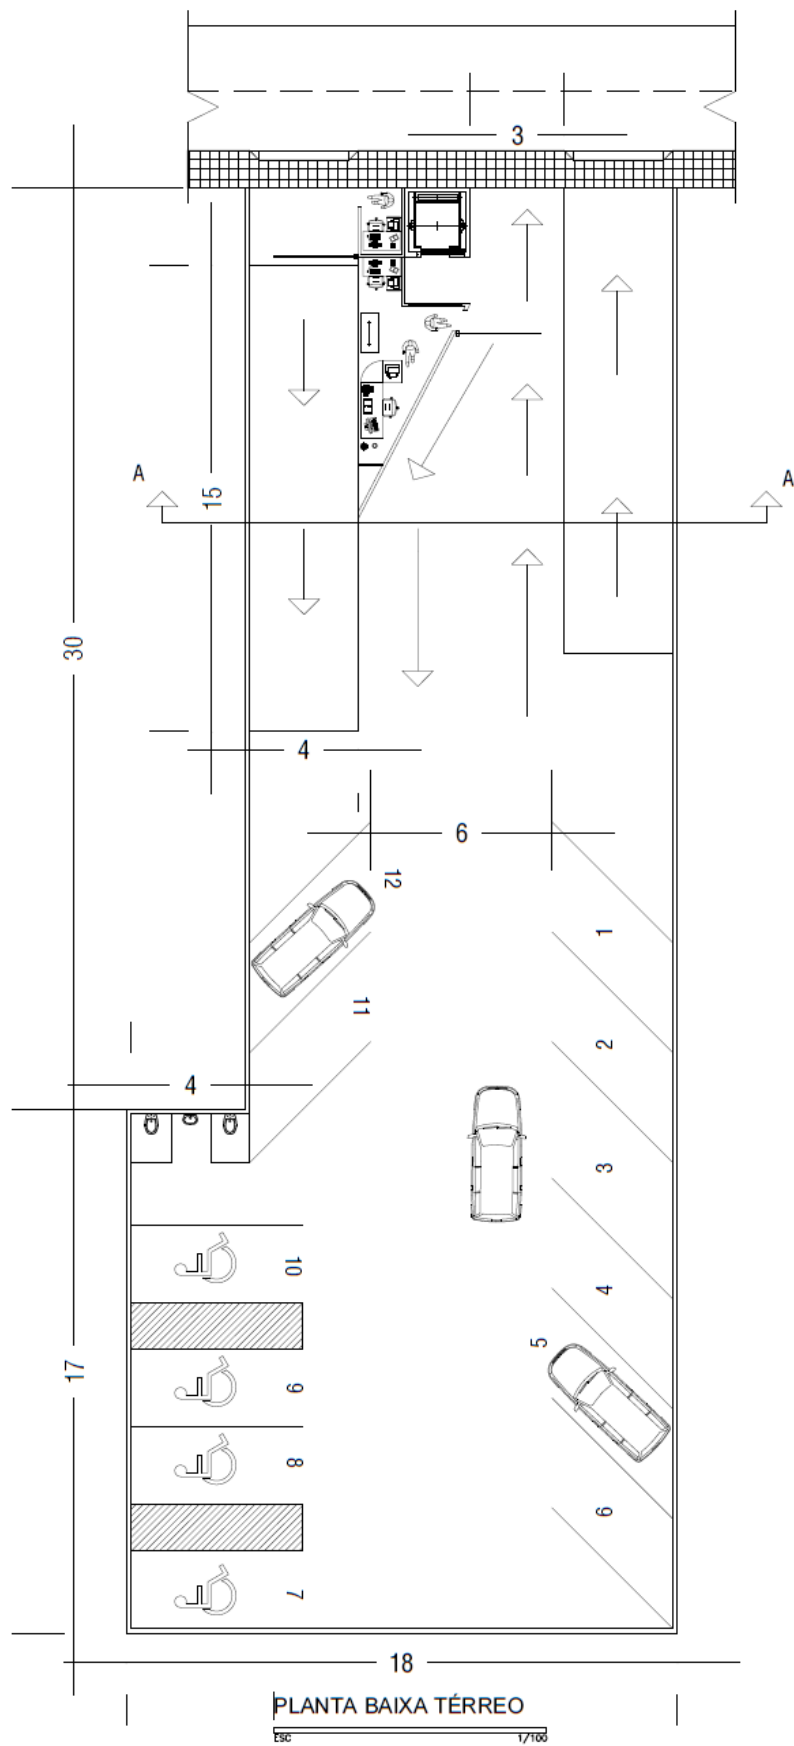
Planta baixa do térreo do edifício-garagem (medidas em metro).
